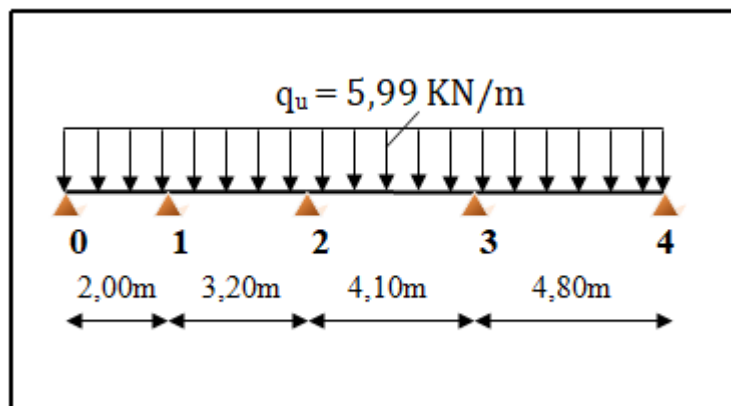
schéma statique des poutrelles à l'ELU (2^{ème} cas).
